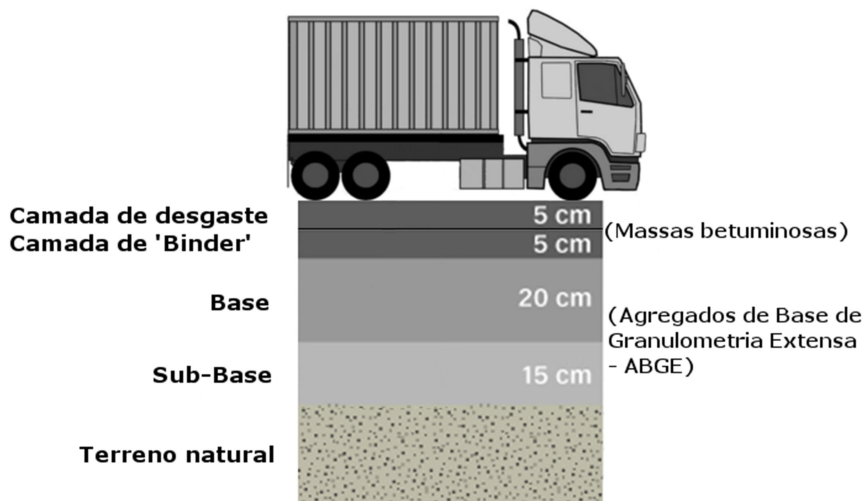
Camadas típicas constituintes do pavimento de uma estrada.
